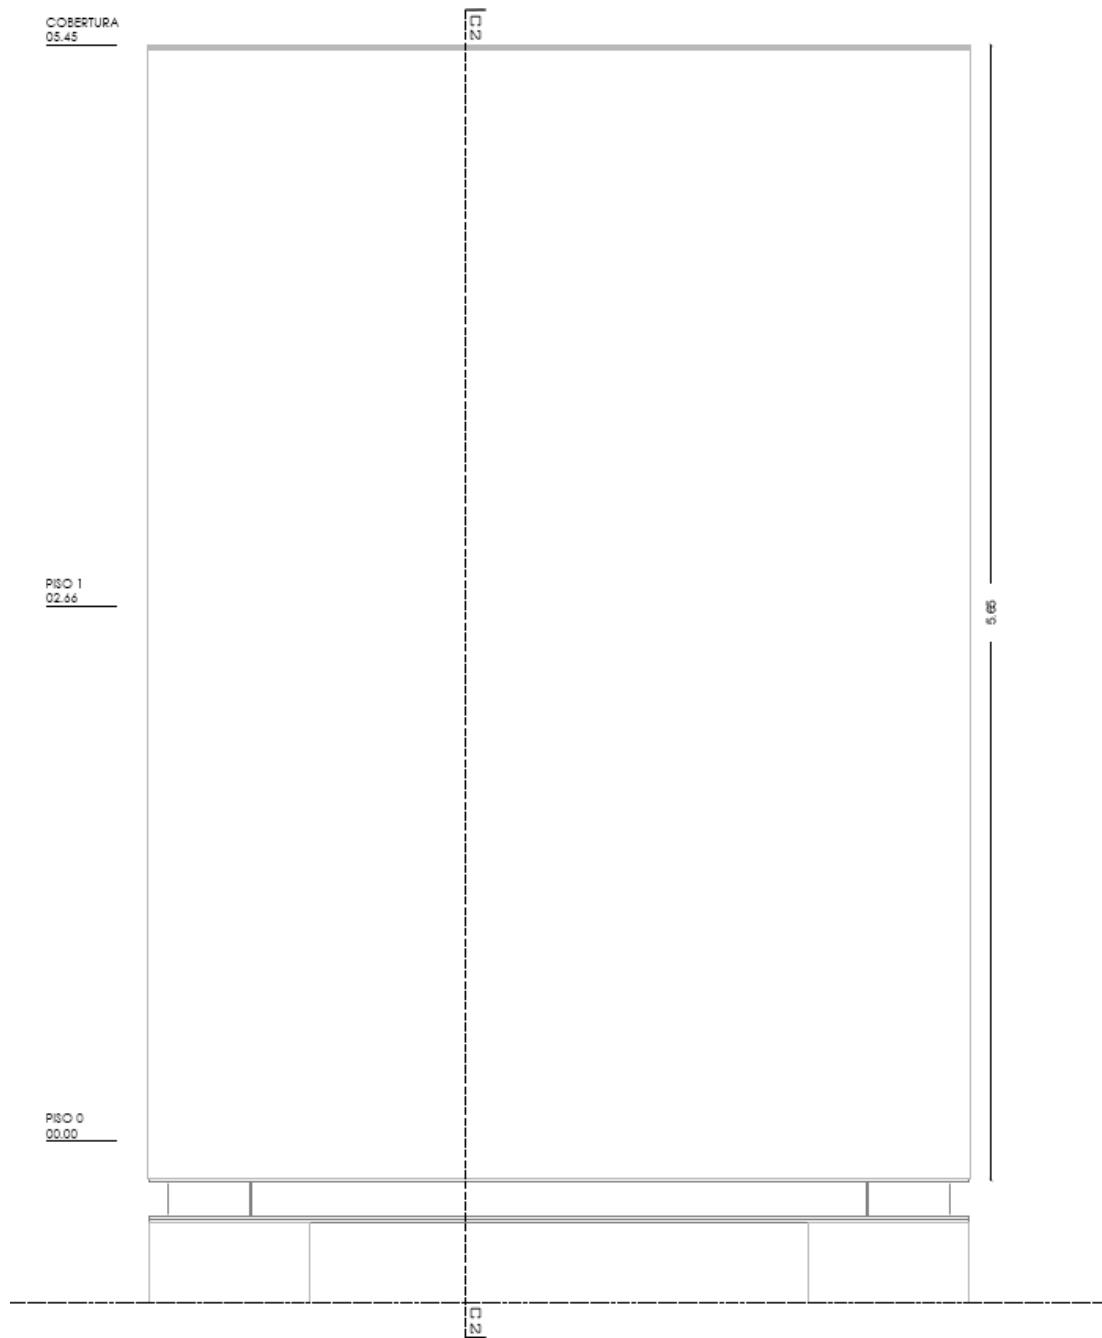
Alçado Lateral Direito – “Construção Piloto”
